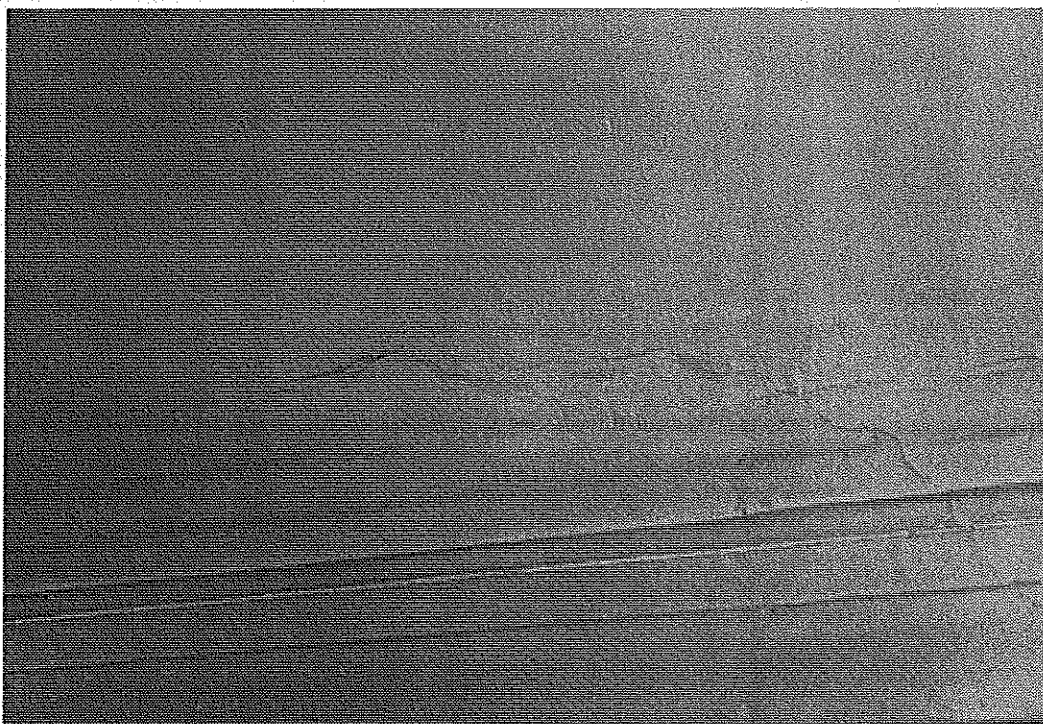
Étage sous-jacent, fissure infiltrante en plafond (zone sous terrasse en retrait). © J. Putatti
